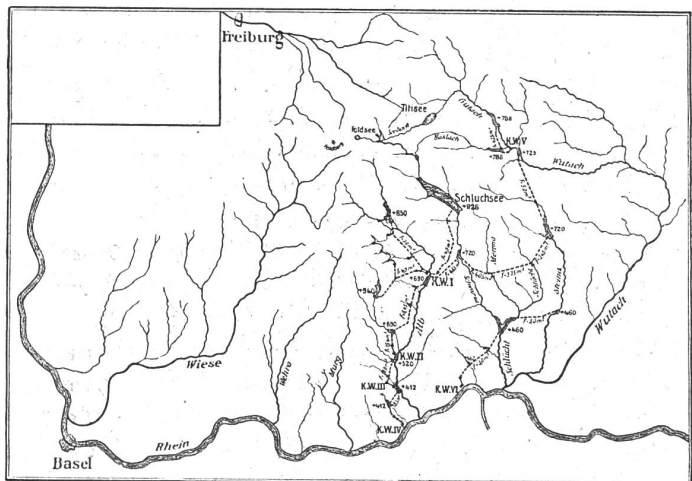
Übersichtslageplan - Entwurf „Sammelpunkt“.
